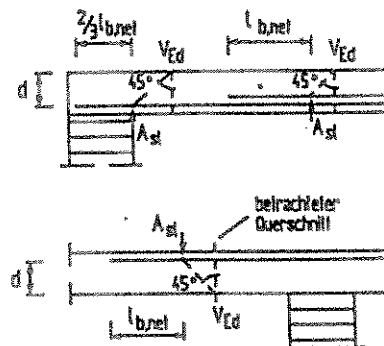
Querkraftmodell für Bauteile ohne Schubbewehrung
